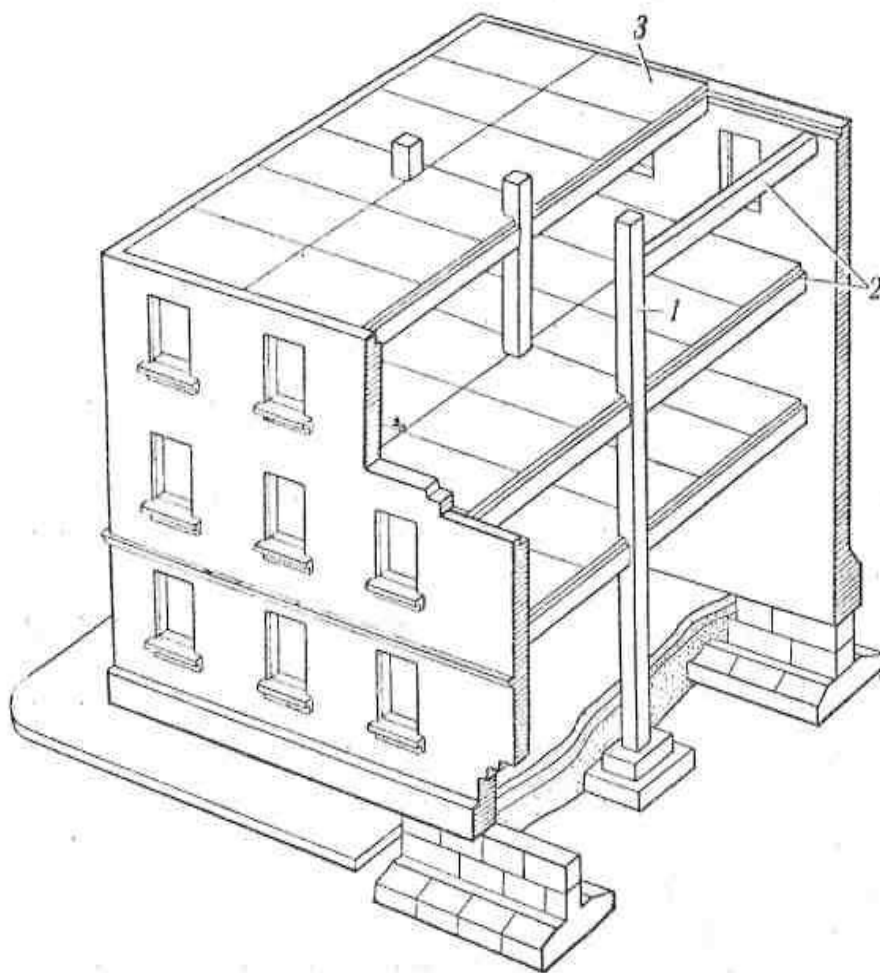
Здание с самонесущими стенами и каркасом:
